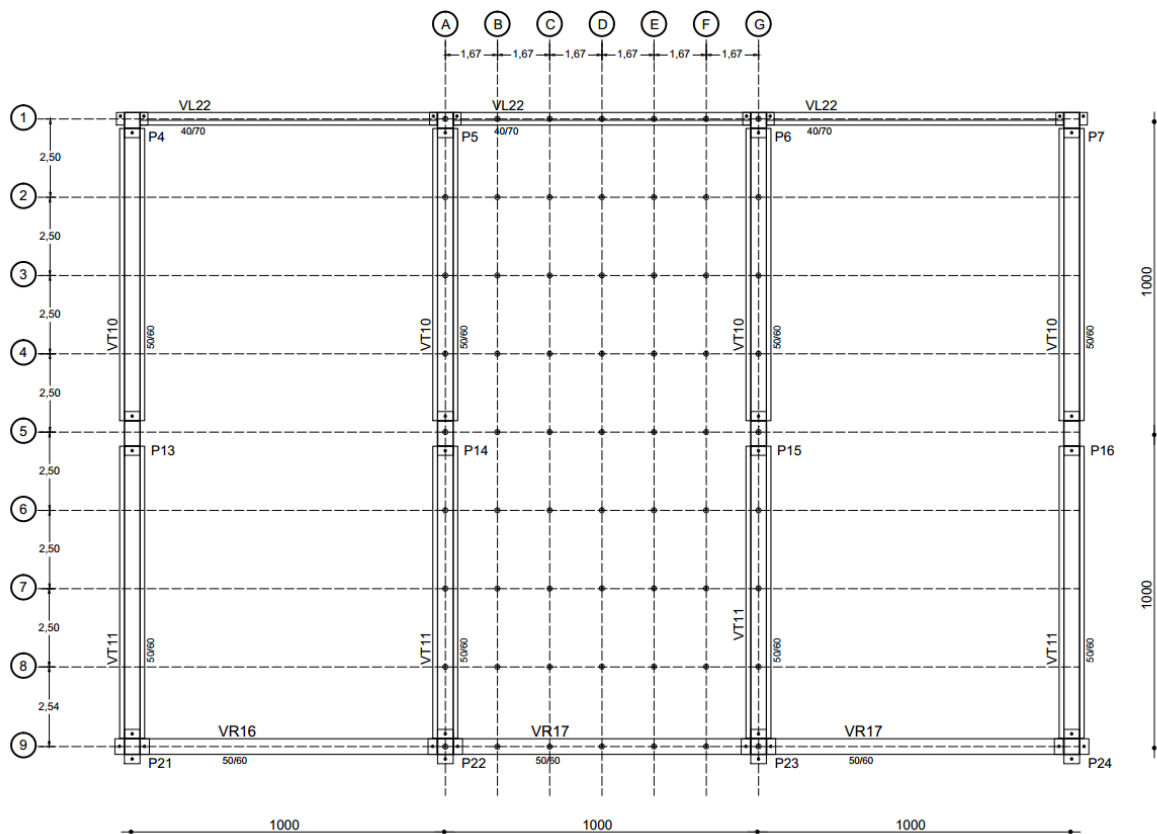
Esquema do ensaio – pavimento com capa estrutural
